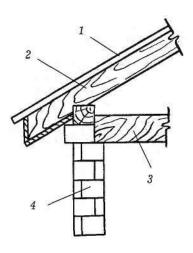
Фрагмент конструкции кирпичной стены: 1— стропильная нога; 2— кровля; 3— деревянная балка; 4— кирпичная стена беседки
